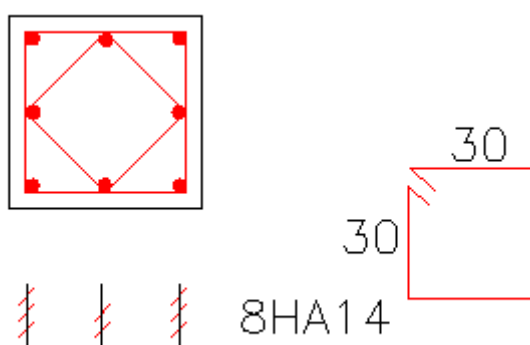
Schéma de ferrailage des poteaux (35×35)
